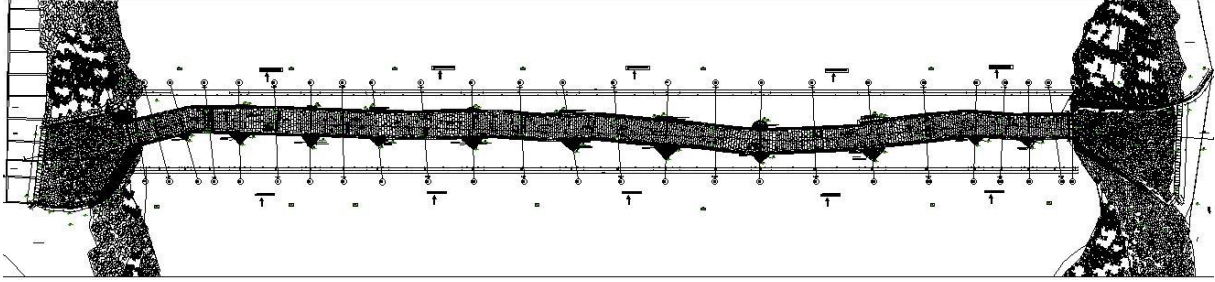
Murat Köprüsü Memba Görünüşü
